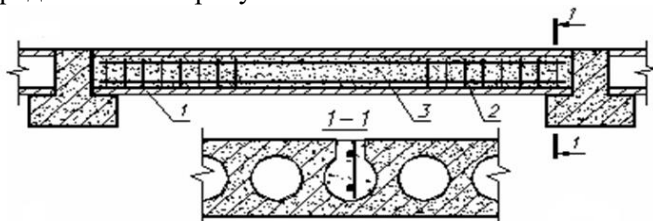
Вариант усиления многопустотной плиты перекрытия установкой дополнительной арматуры: 1 – плита; 2 – сварной каркас; 3 – бетон
